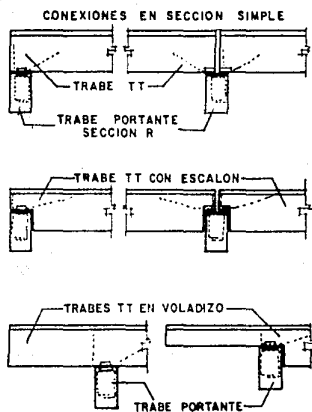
Conexiones en sección simple - (generalmente para cubierta) - de trabelosas "TT" con traves portantes de sección rectangular.
